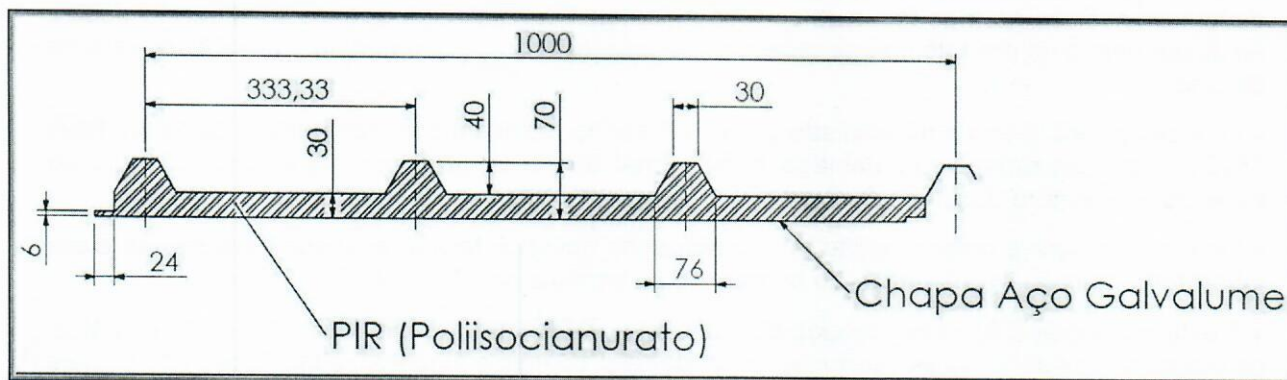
Seção transversal do painel de telhado (Dimensões em mm).
